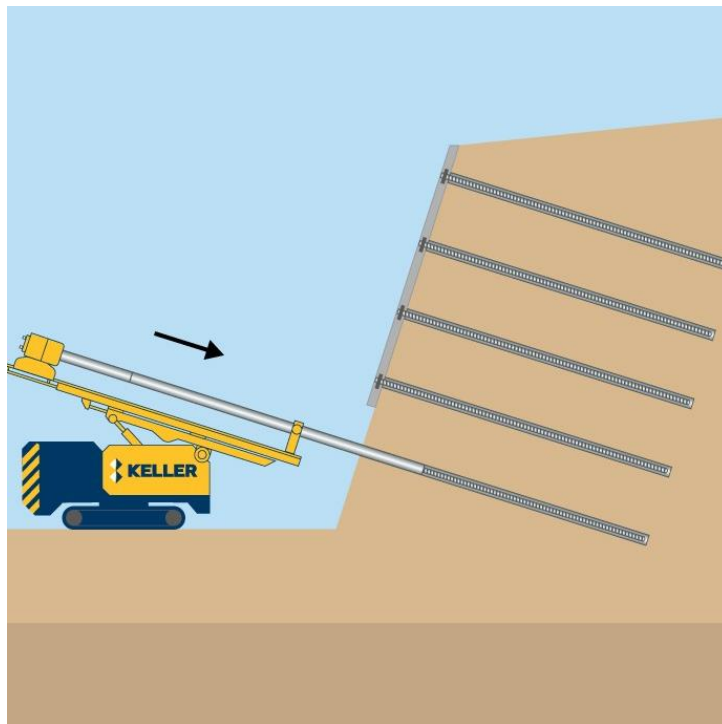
Esquema de construcción de soil nailing (Keller, 2021)
